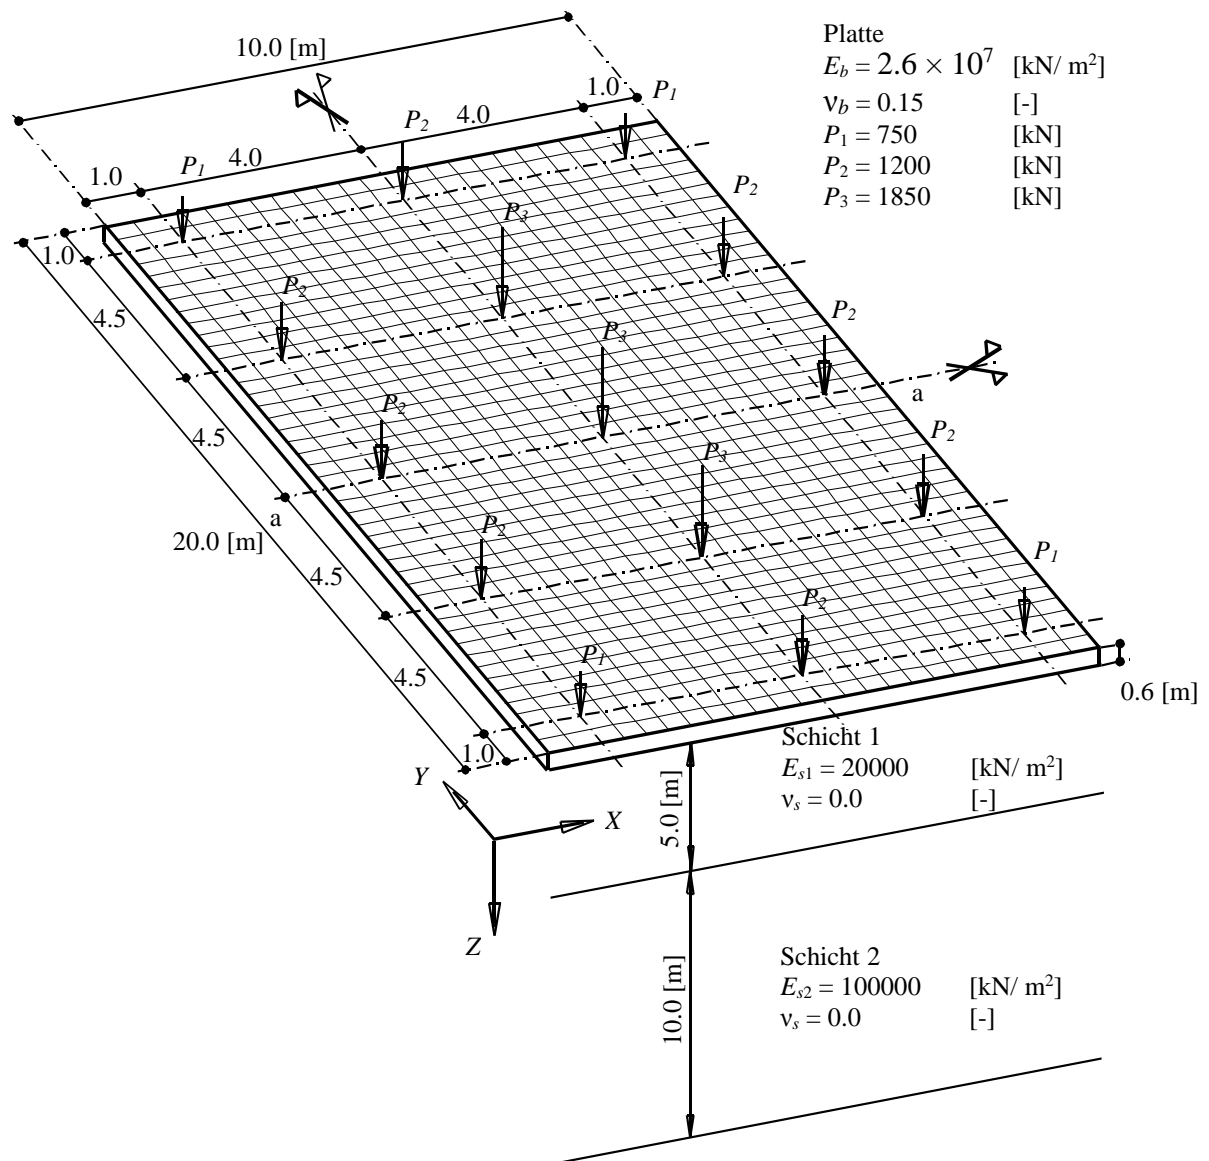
Grundriss der Platte, Belastung, FE-Netz und Schichtung des Baugrunds
